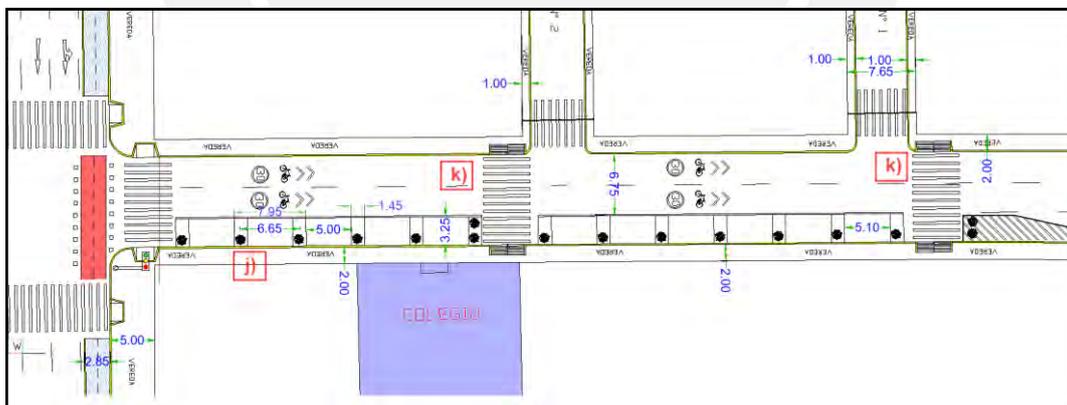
Vista en planta de situación propuesta en la Av. Cangallo cruce con Bauzate y Meza.
